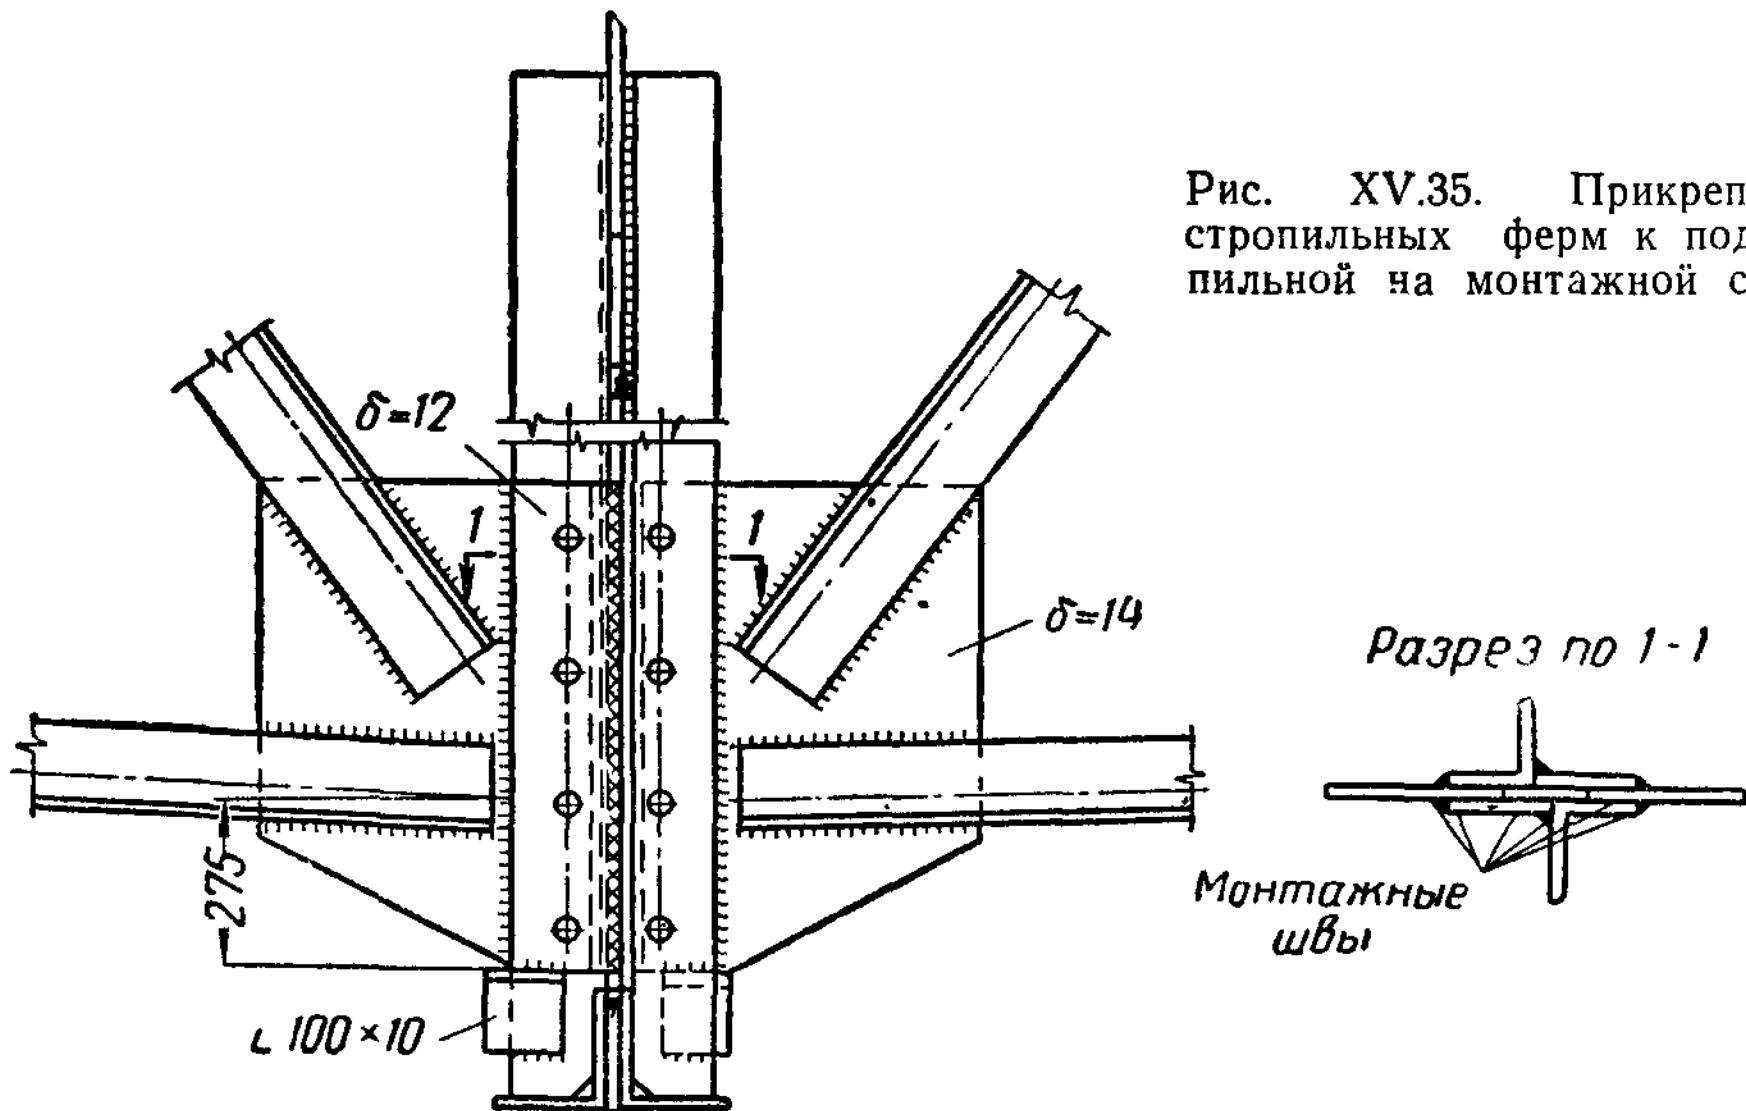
Прикрепление стропильных ферм к подстропильной на монтажной сварке
